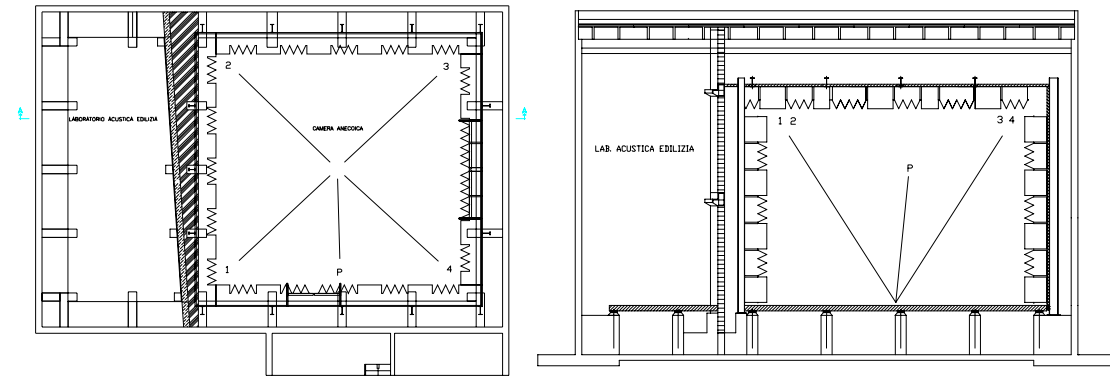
Pianta e sezione della camera con tracciamento delle diagonali.
